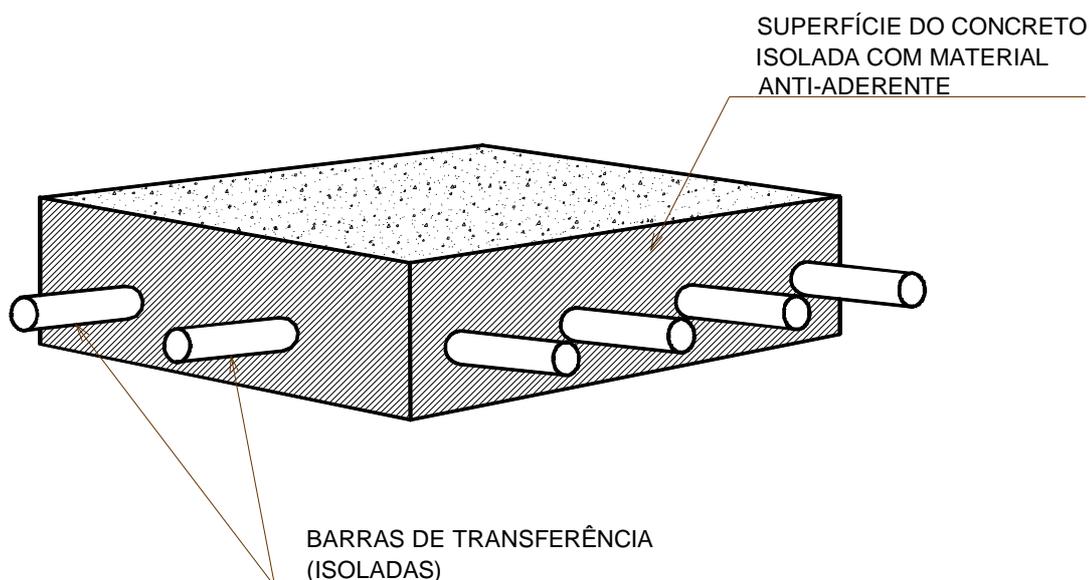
Detalhe da placa de concreto pronta para a segunda etapa da concretagem.
